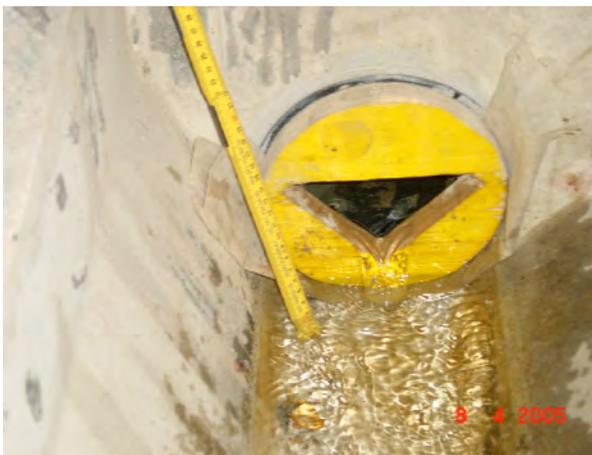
Durchflussmessung mit Dreiecküberfallwehr im Gewölbedrainageschacht
